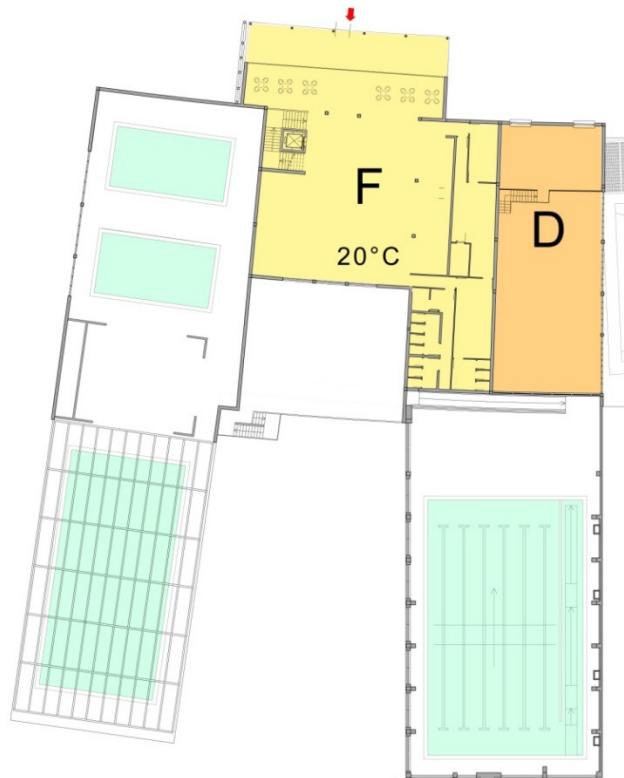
Pianta piano primo divisa per temperature e per zone (pianta fuori scala).
